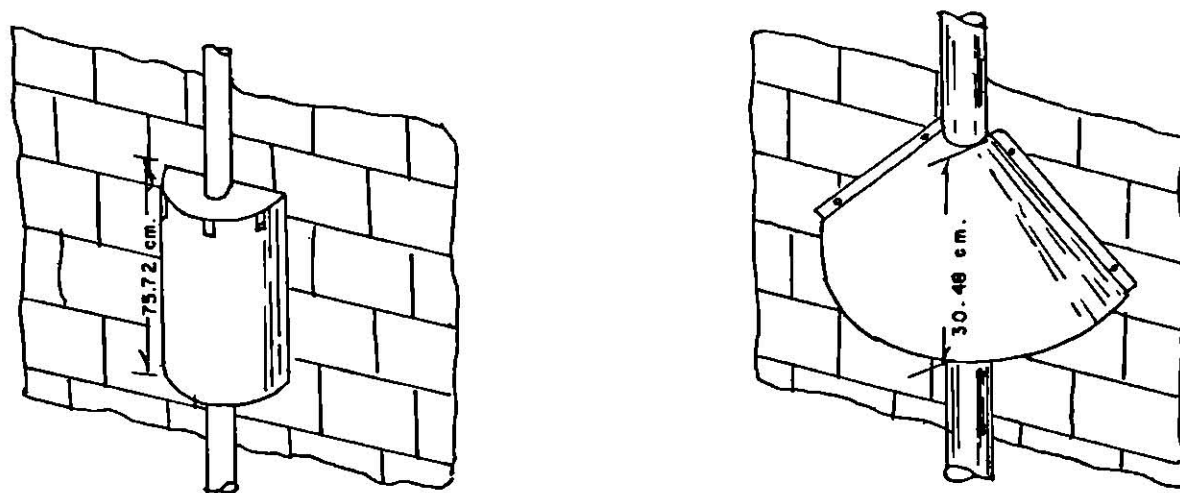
Tipos de guardas de metal para tuberías en las paredes.
